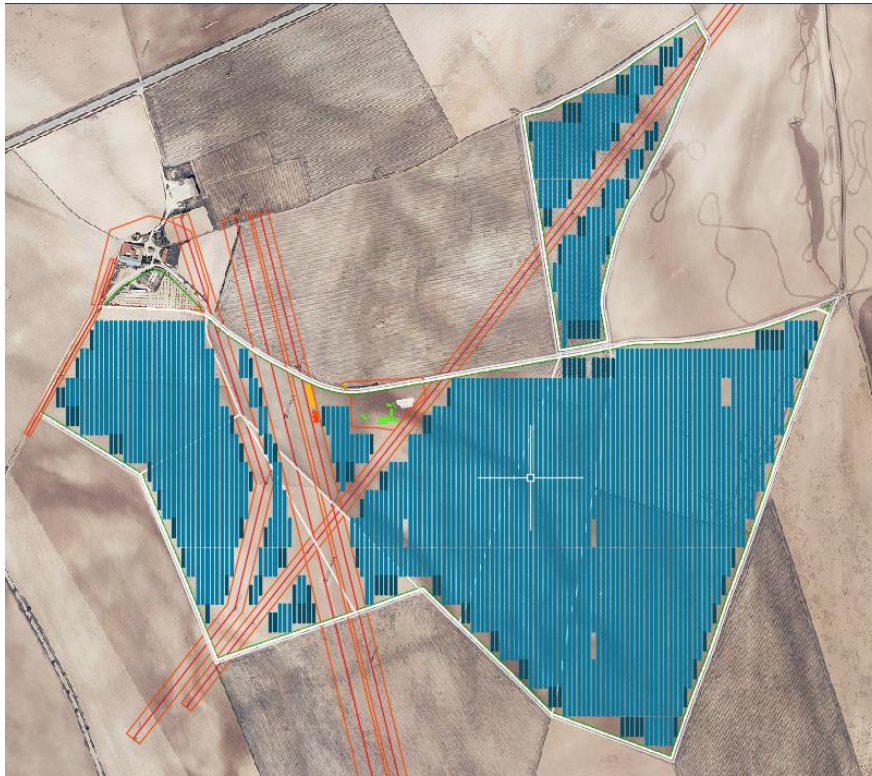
Layout de la planta tras el proceso iteración. Fuente Propia.
